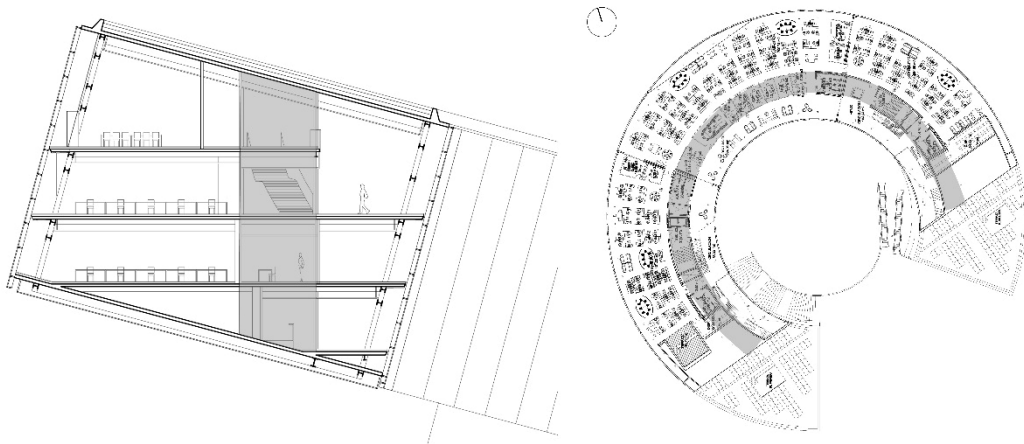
Sección central del edificio Zero y plano de la planta segunda donde se observa la galería de circulación orientada al sur y el espacio de trabajo orientado a norte
